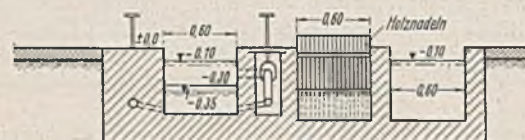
Querschnitt durch Schleuse und Rücklaufrinnen.
